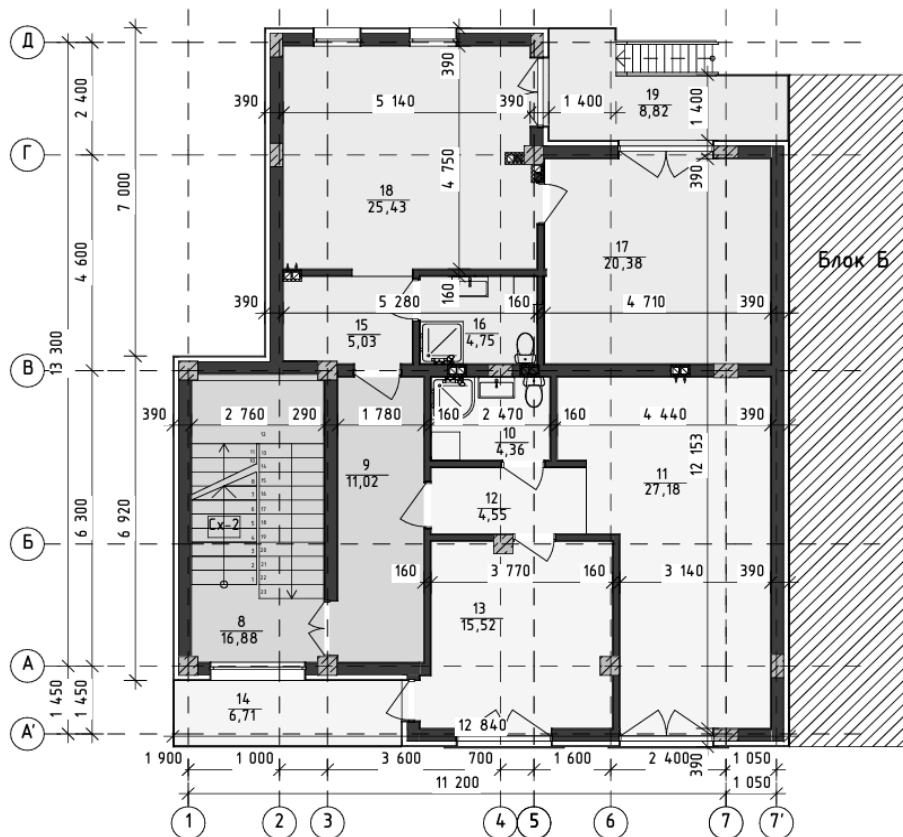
План типового 2-го та 3-го поверху житлового будинку
